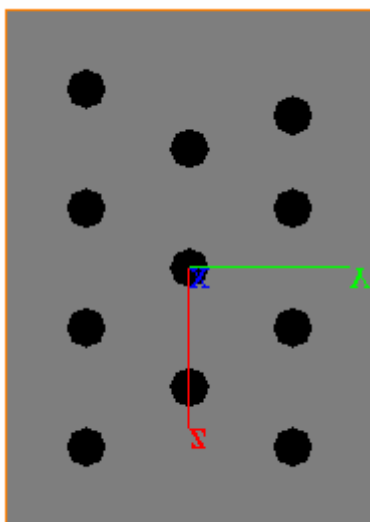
Vista planimetrica del modello GROUPv2016.
